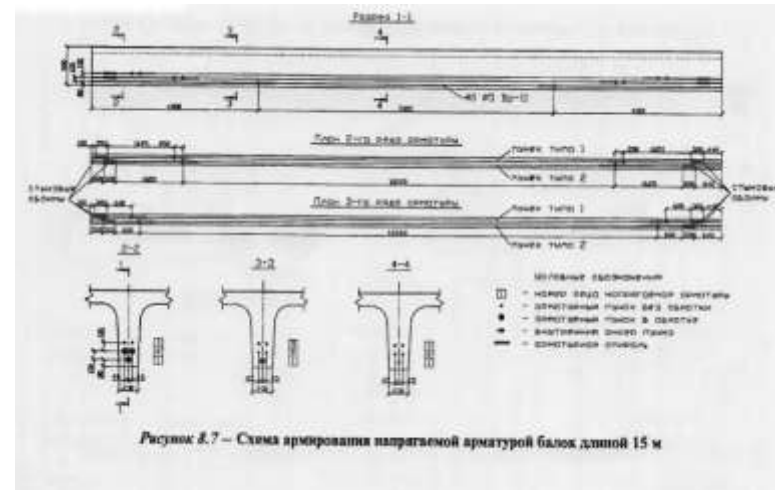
Схема армирования натяжной арматуры балок длиной 15 м
